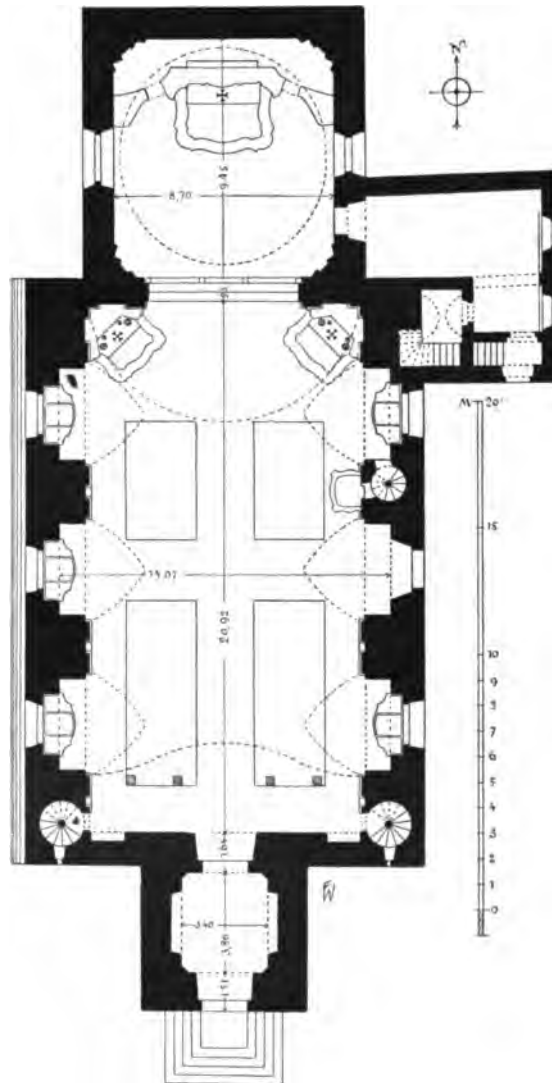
Habsberg. Grundriß der großen Wallfahrtskirche.
